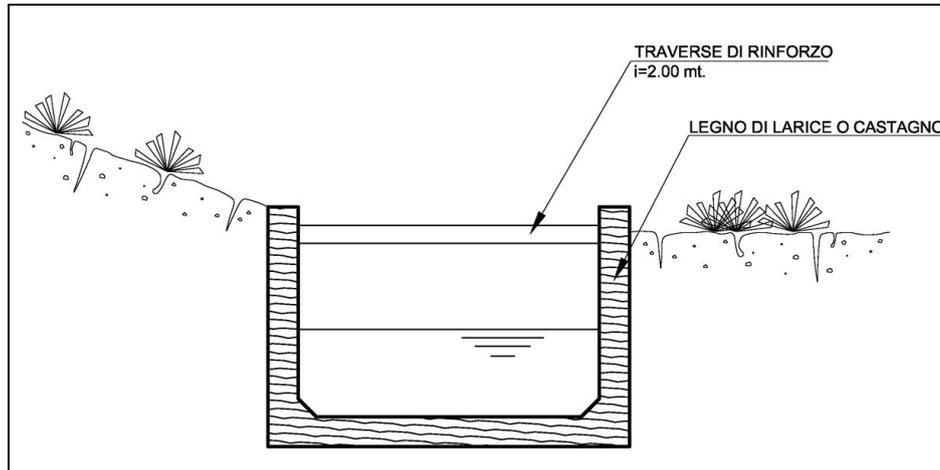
Compiuvio centrale – Canaletta ad U in legname
